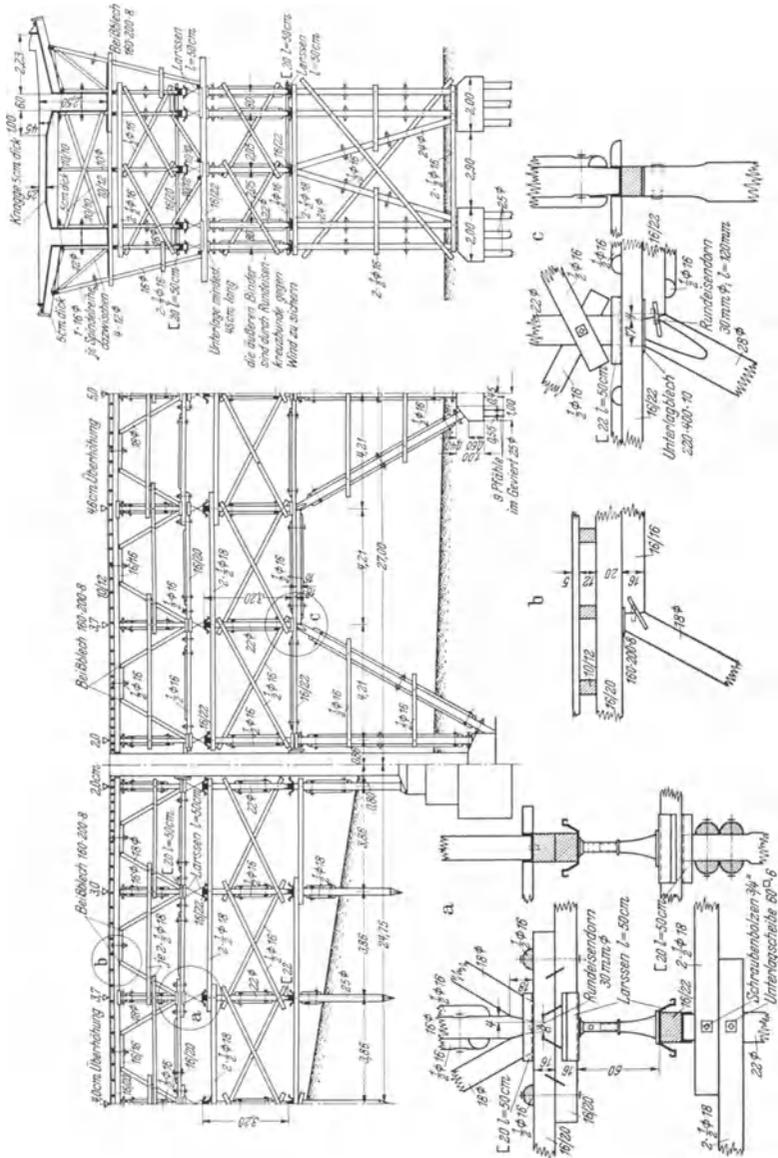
Schalgerüst des Überganges bei Denkendorf.
